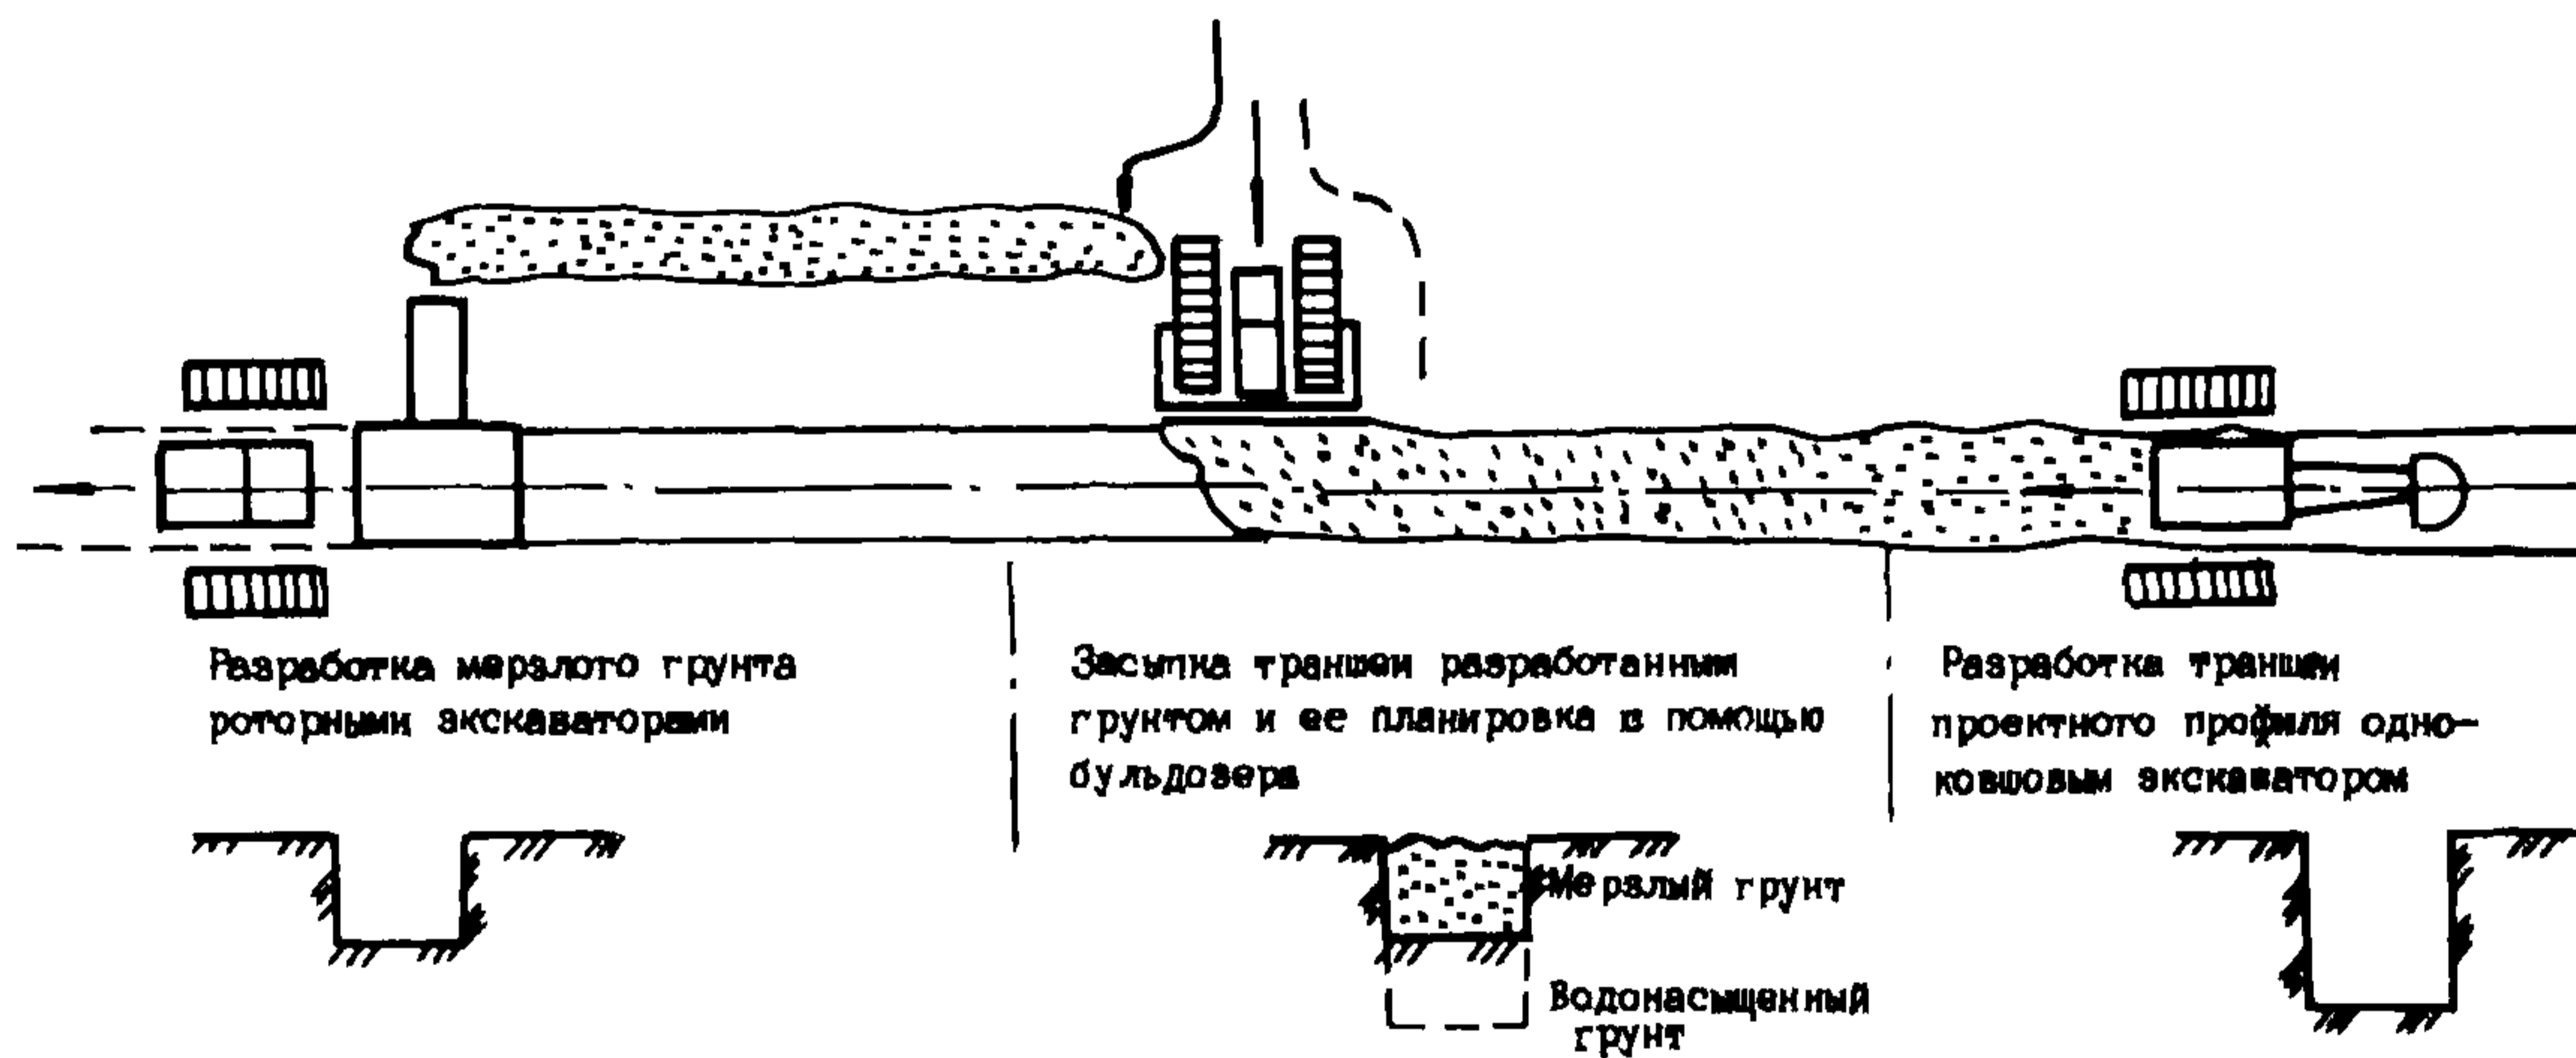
Разработка траншей в мерзлых грунтах, подстилаемых водонасыщенными грунтами
